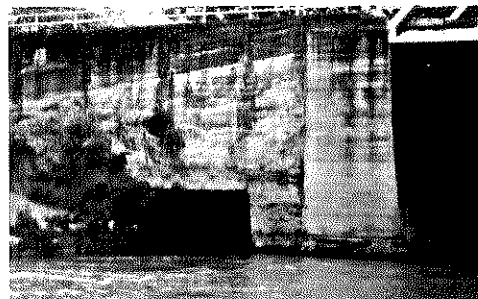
Socavación en estribo y posterior colapso parcial. Puente Sabandija - Regional Tolima
